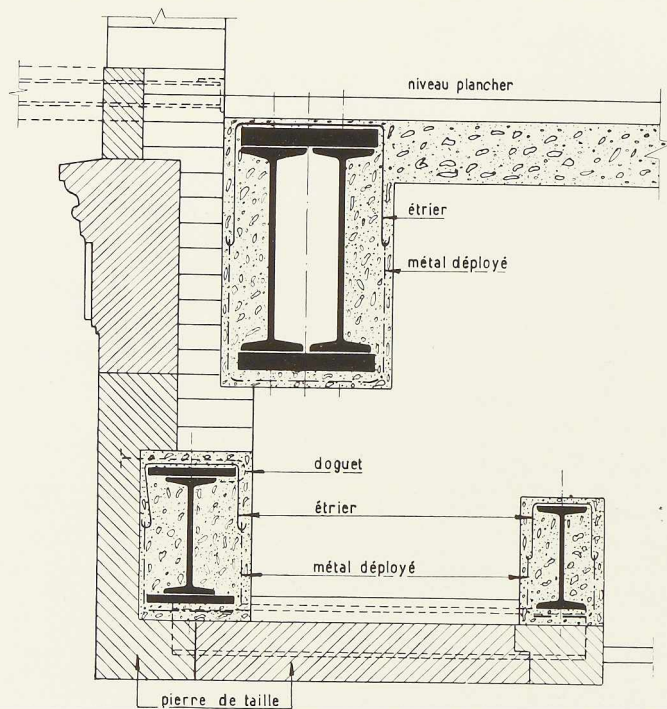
Détail d'enrobage des grandes poutres en façade au niveau du premier étage.
